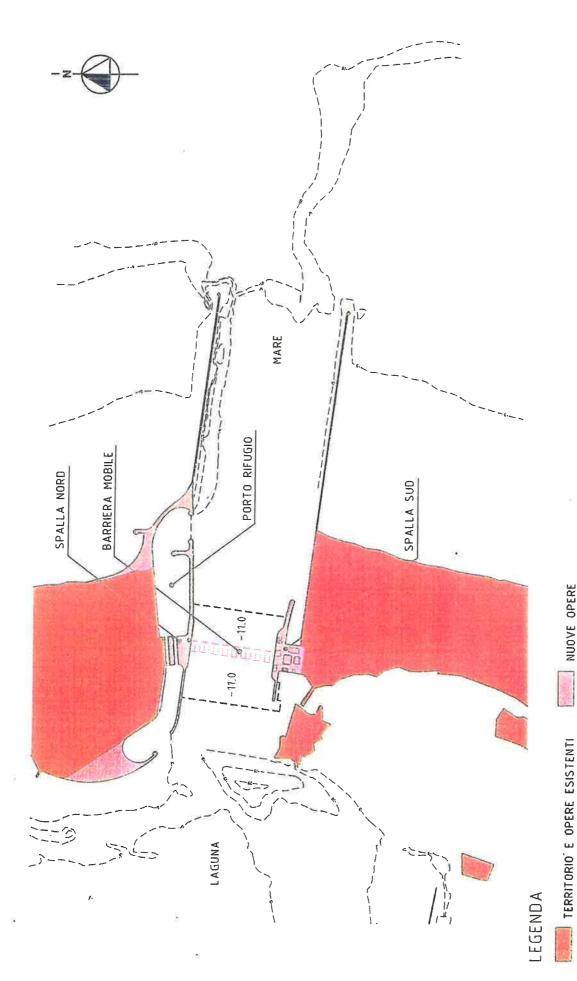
🛎 Bocca di Chioggia – Planimetria delle opere
